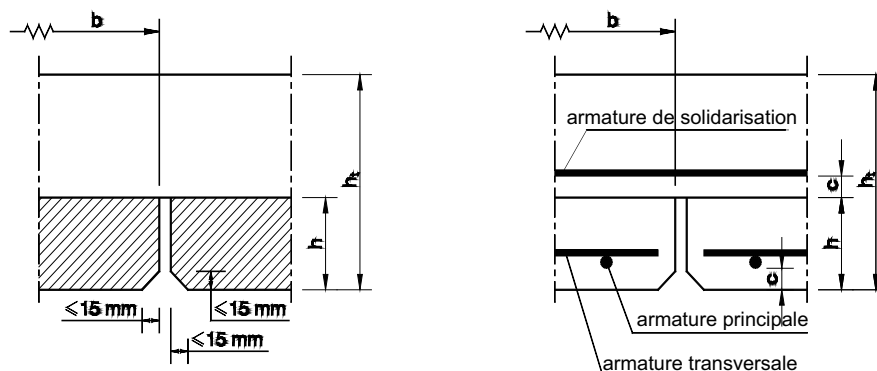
a -Prédalles sans bord latéral chanfreiné supérieur : Liaison transversale avec armatures horizontales
